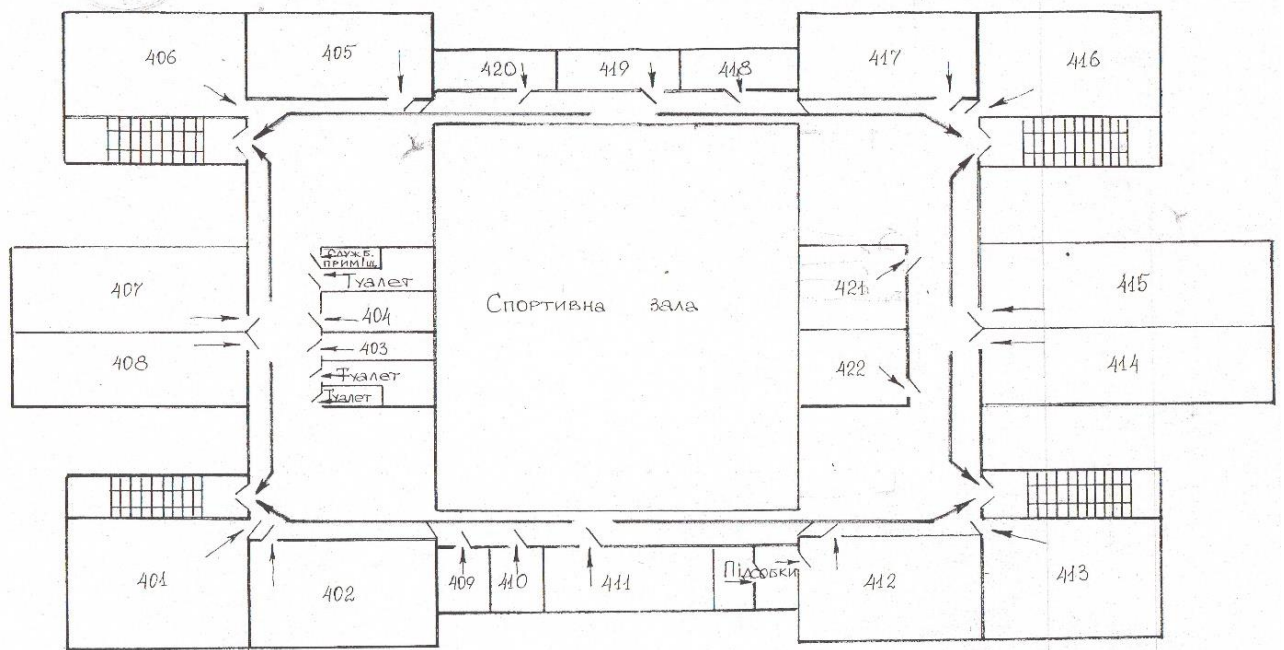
План 4-го поверху БАЛ «Гармонія»
